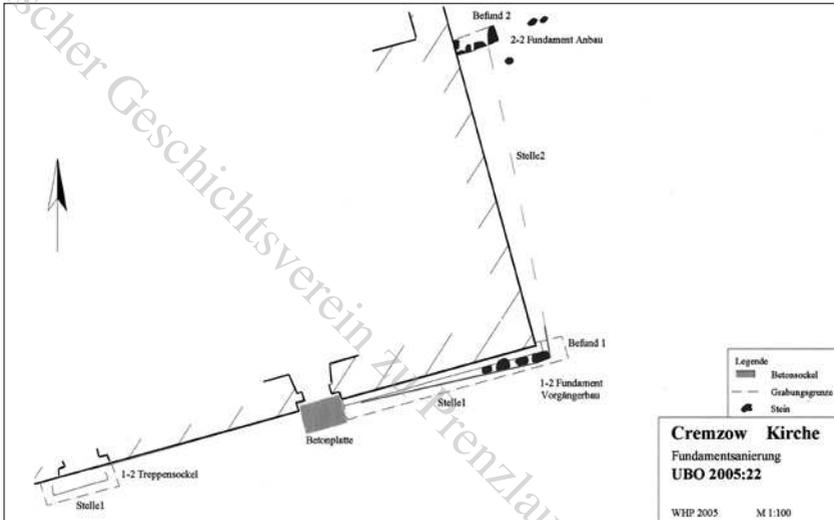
Kirche Cremzow, Gesamtplan mit Befunden (Plan: A. Hahn-Weishaupt)
